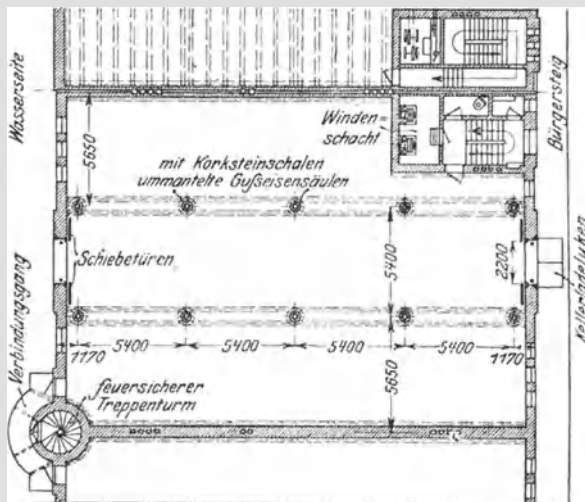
Grundriß eines Hamburger Speichers. Maßstab 1 : 370.
